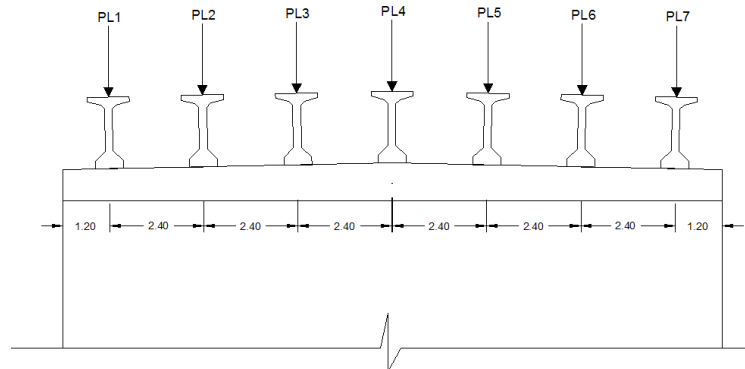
Ubicación de las cargas vivas vehiculares para pila 1.
